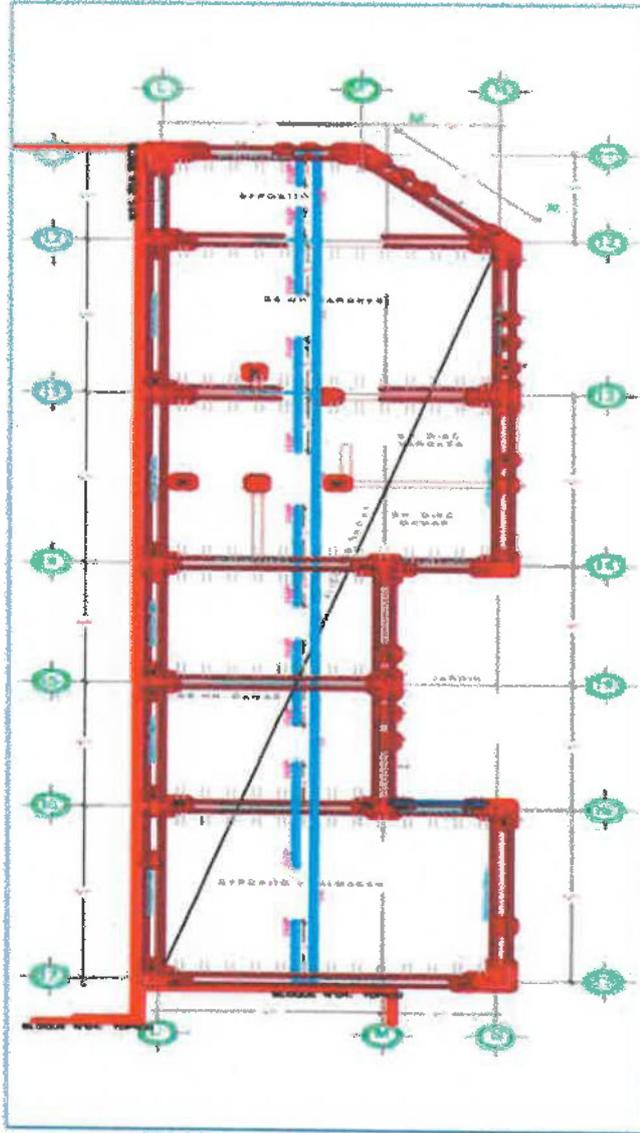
Plano estructural típico 1º y 2º nivel de vigas y aligerados.
